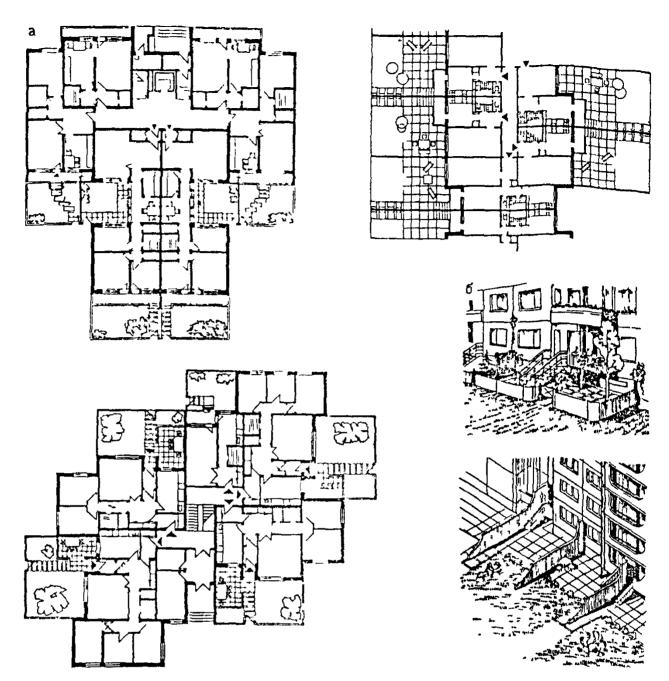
Площадки и открытые помещения у квартир иервого втажа
